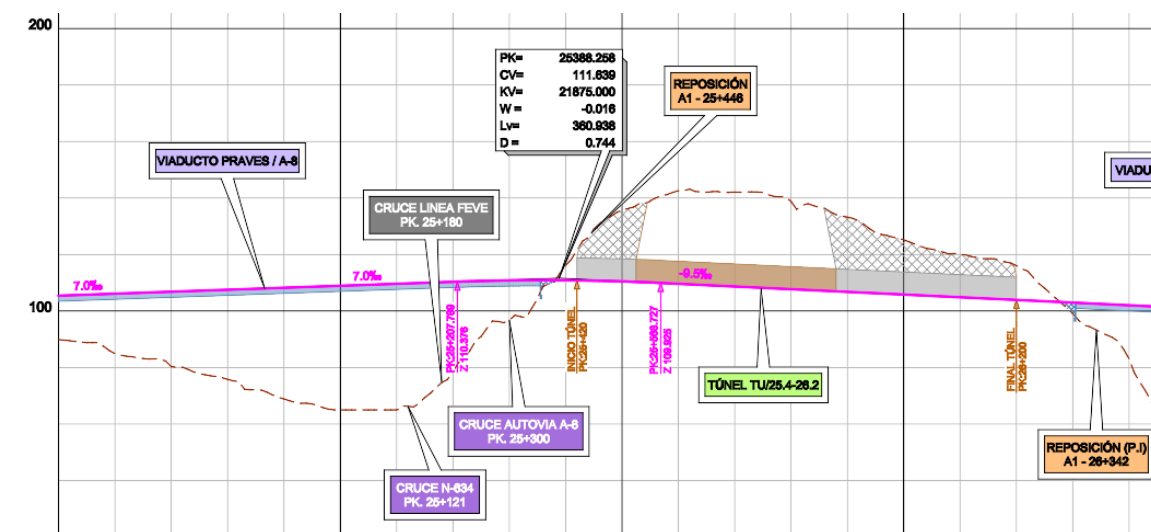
Perfil longitudinal Alternativa A1 rasante baja. Cruce red de ancho métrico (RAM) y A-8 en proximidades de Praves.
